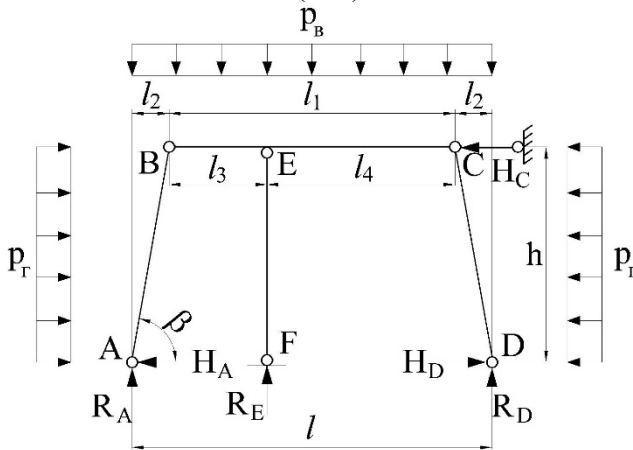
Расчетная схема трапециевидной усиленной крепи
